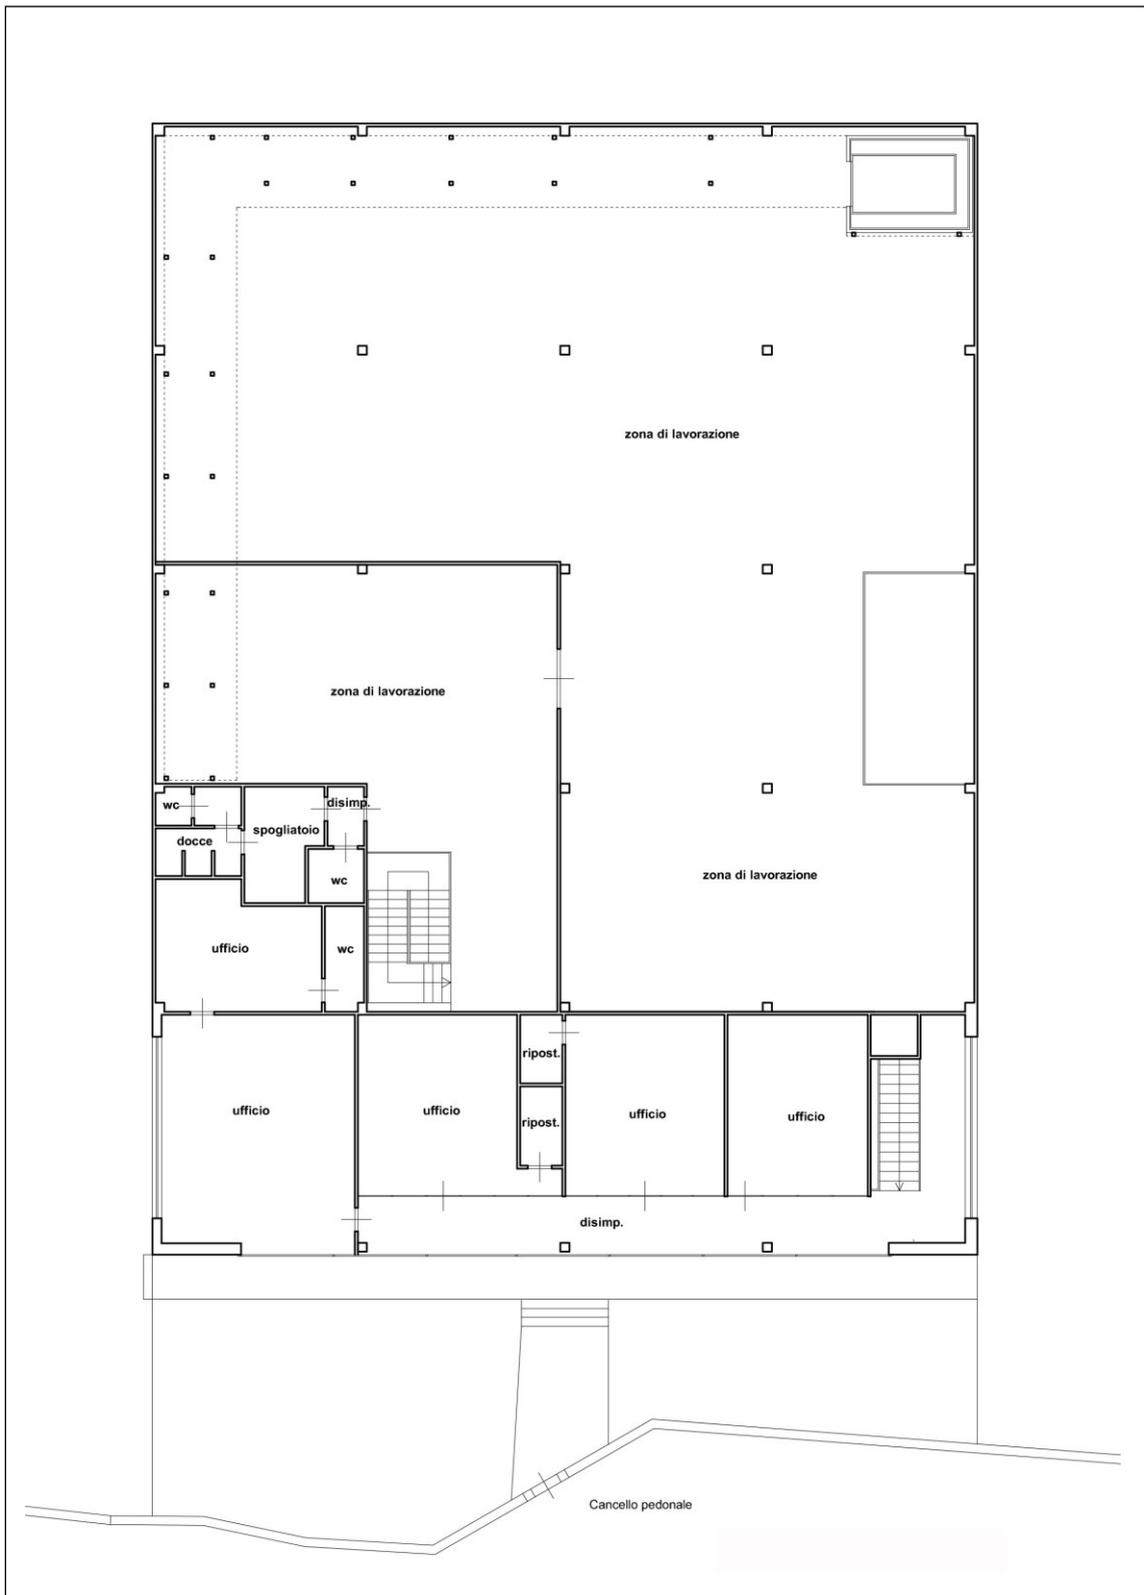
Rilievo dell'immobile pignorato. Primo piano.
